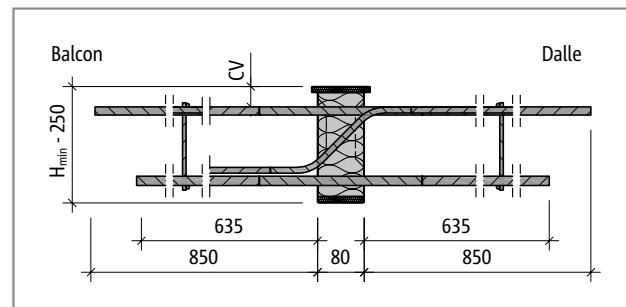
Schöck Isokorb® T Type K-M13 : Coupe du produit
